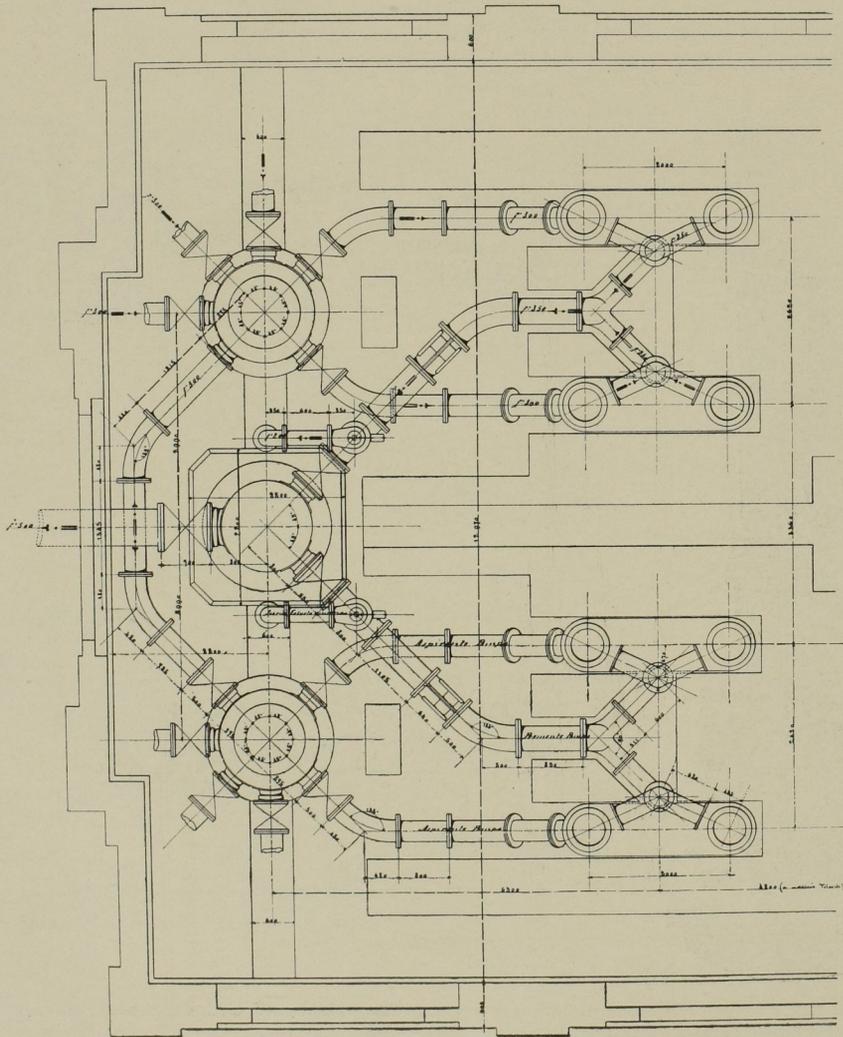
Grundriss der Rohrleitungen und Windkessel. Masst. 1:75.
